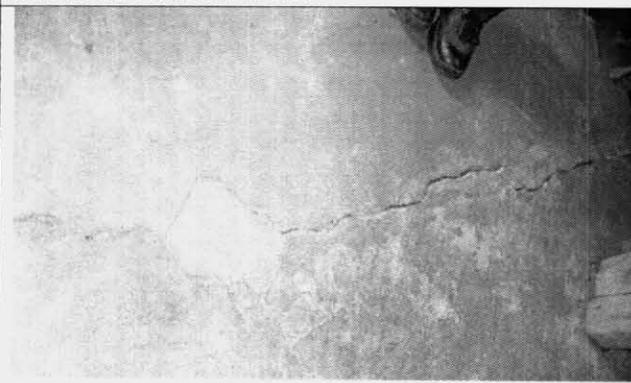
Agrietamiento en pisos, vivienda ubicada en la transversal 4 A este # 61-08.
